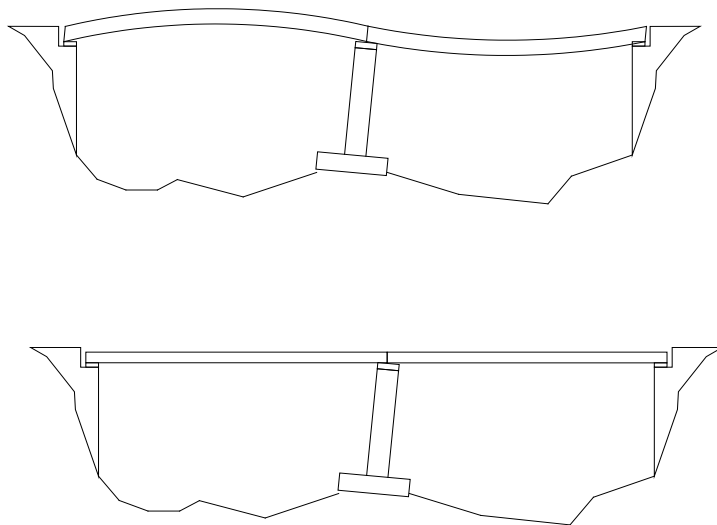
Giro transversal en pilas, puente isostático e hiperestático.
